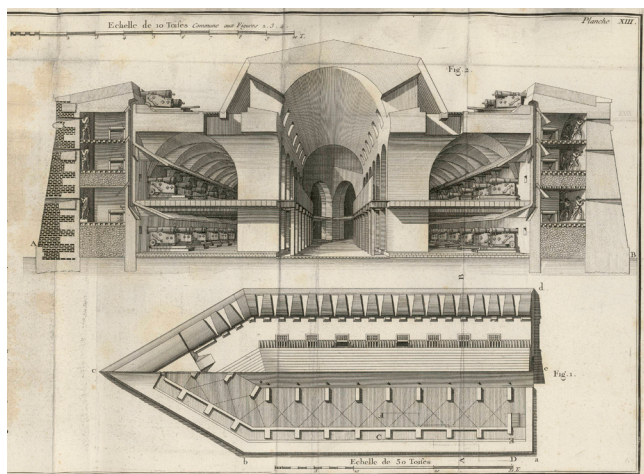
Lámina XIII de *La fortification perpendiculaire* de Montalembert. Puede observarse el apilamiento de cañoneras en una estructura acasamatada y la planta de la caponera tipo del sistema poligonal (Biblioteca Central Militar, V-68-3-1/1) (25)
